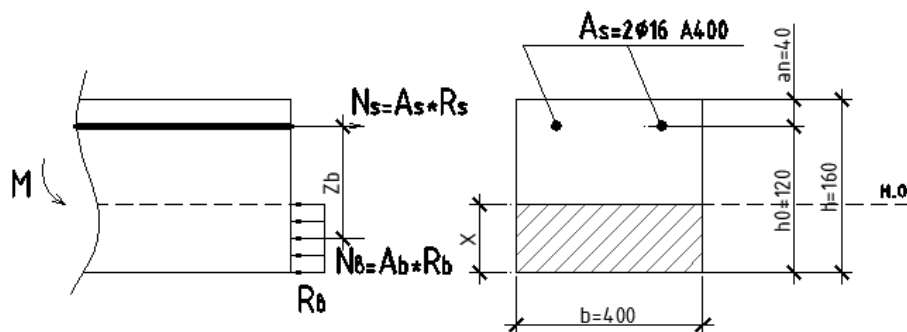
Схема внутренних усилий главной балки Г.б-1 на опоре
